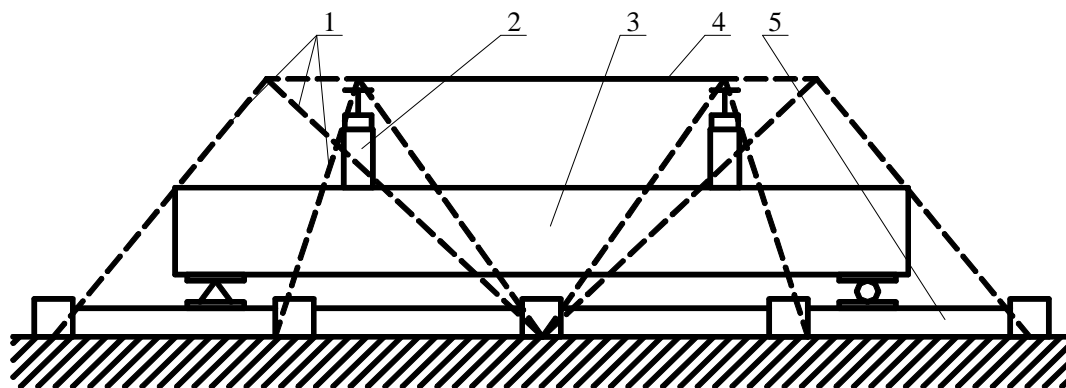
Схема сборно-разборного стенда: 1 – раскосы; 2 – гидравлические домкраты; 3 – испытываемая конструкция; 4 – верхний пояс фермы; 5 – нижний пояс фермы
